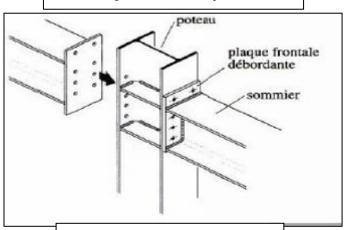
Assemblage de poteau-poutre Source : http://detailsconstructifs.cype.fr
